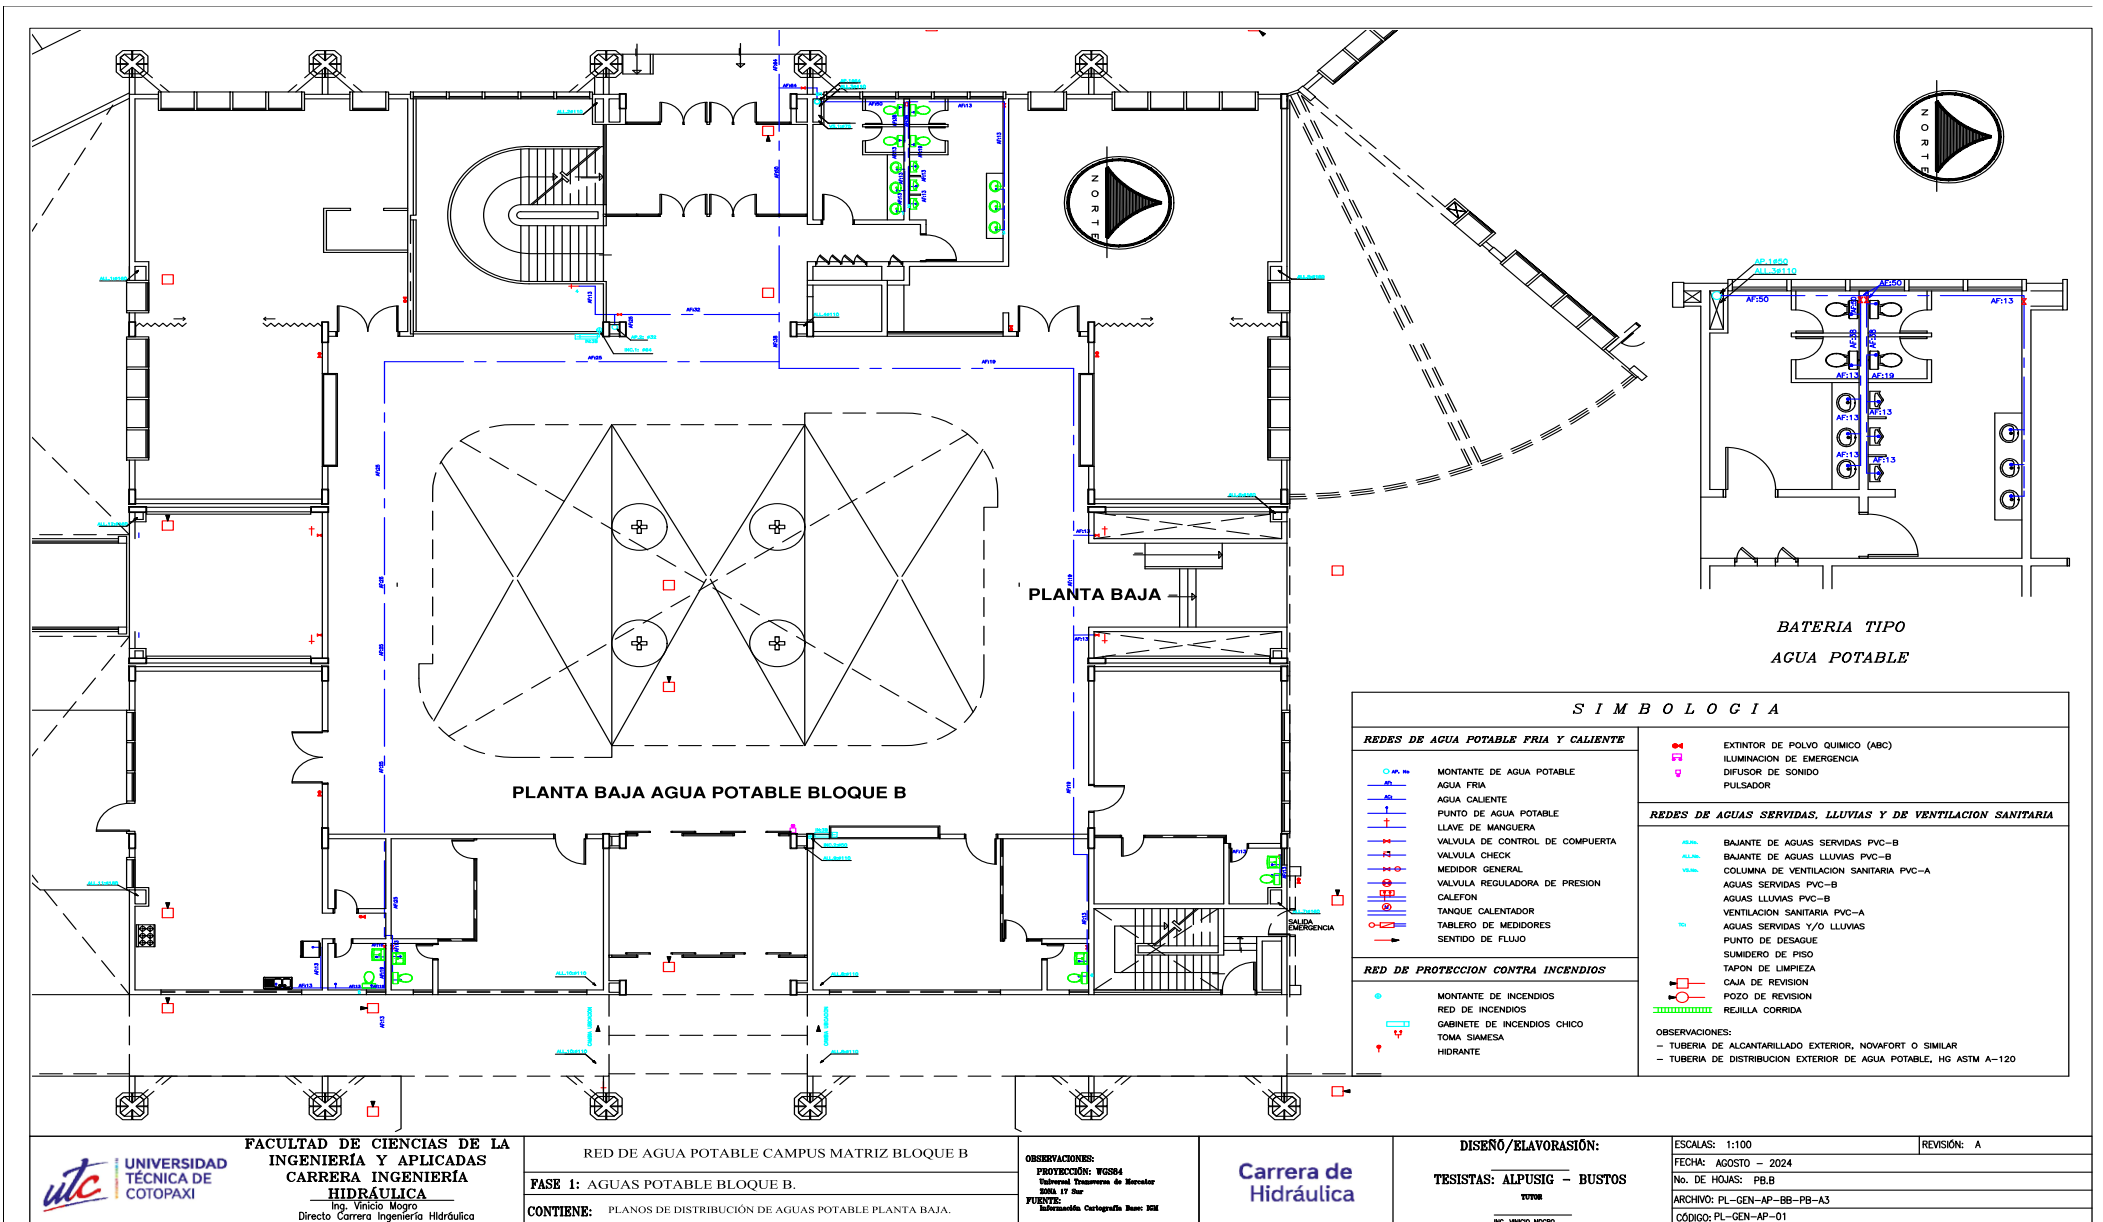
Planos de Distribución de Agua Potable de Agua Potable Planta Baja Bloque B.
